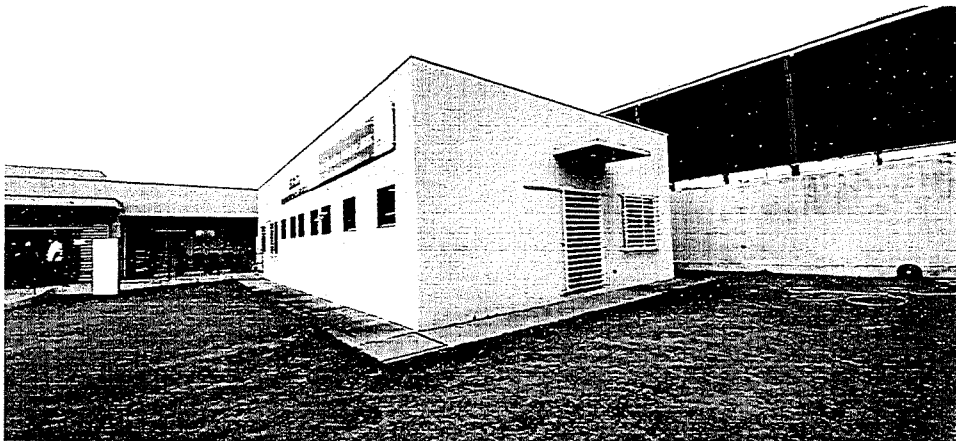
FACHADA LATERAL – LOCAL DA AMPLIAÇÃO.
